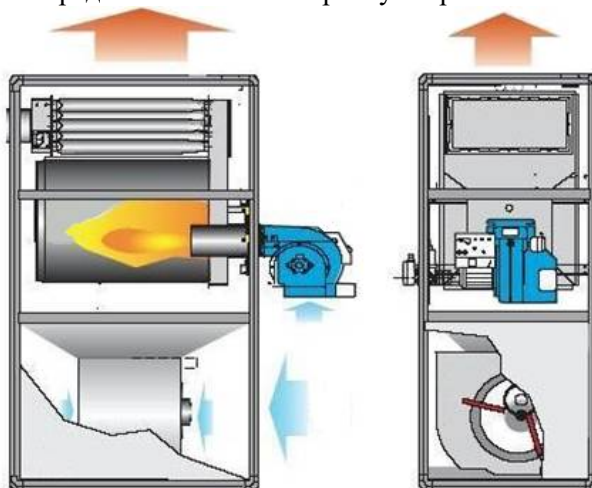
Воздухонагреватели с применением горелки закрытого типа
